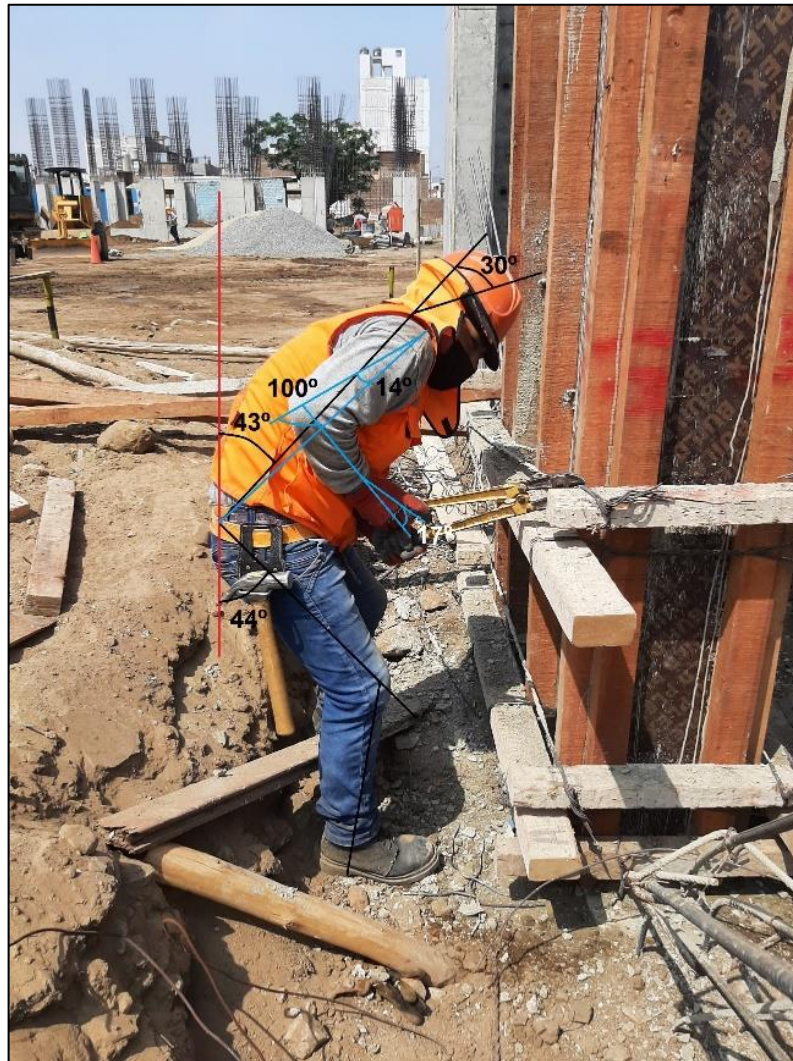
Desencofrado de columnas (REBA – T2), Consorcio Negrón, 2021.
